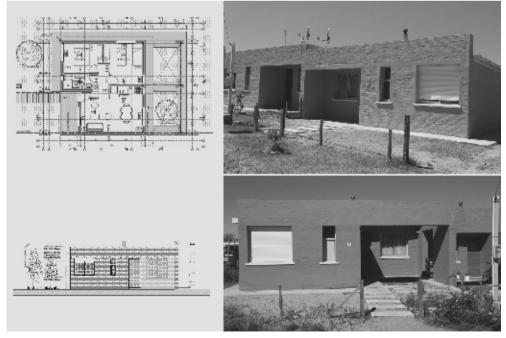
PLAN II. FUENTE: MEVIR (PLANOS) Y EQUIPO DE EVALUACIÓN (FOTOGRAFÍAS).
